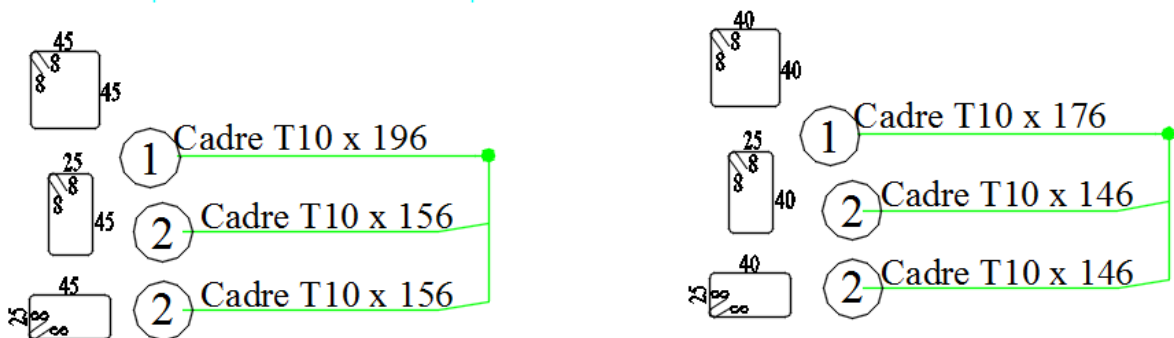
Schéma de ferrailage des poteaux 6^{ème} et 7^{ème}
